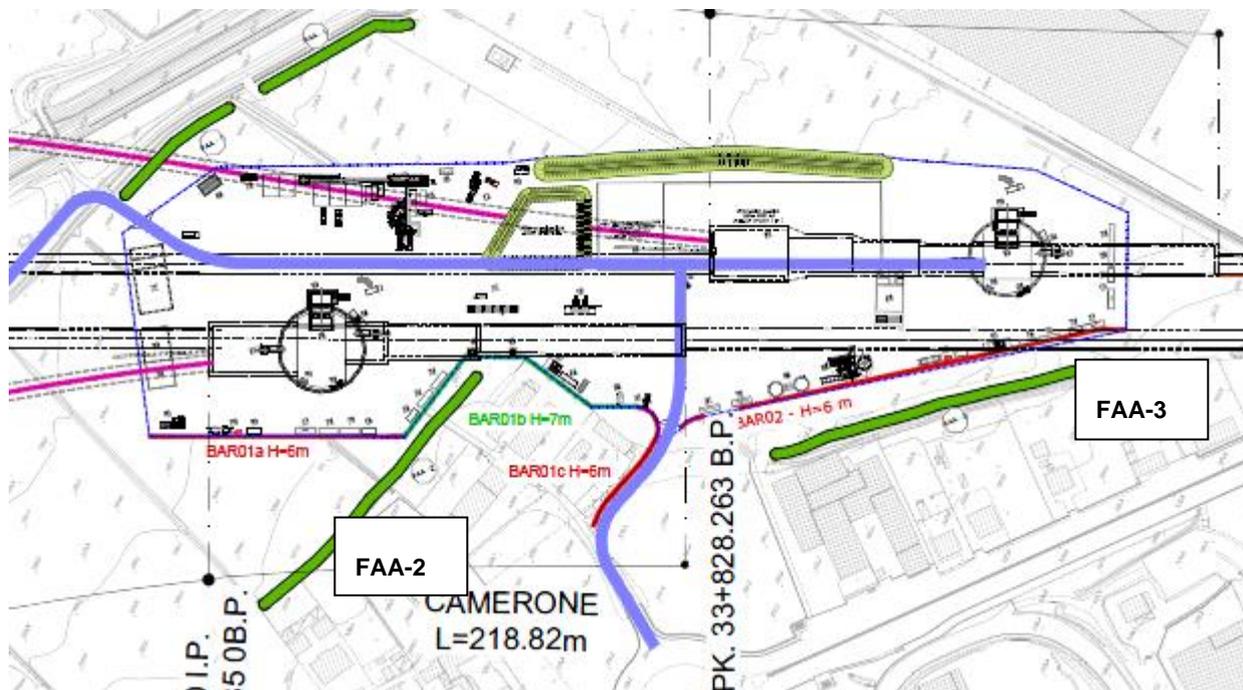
Stralcio planimetrico con la localizzazione delle fasce di vegetazione lungo il margine del cantiere COP6
